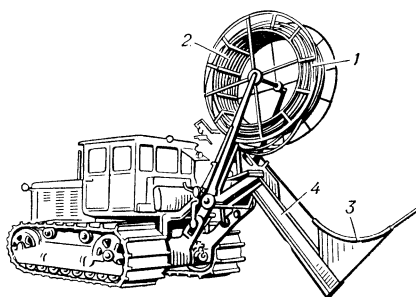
Машина для укладки готовых пластмассовых труб: 1 — барабан; 2 — труба; 3 — направляющий желоб; 4 — нож.
